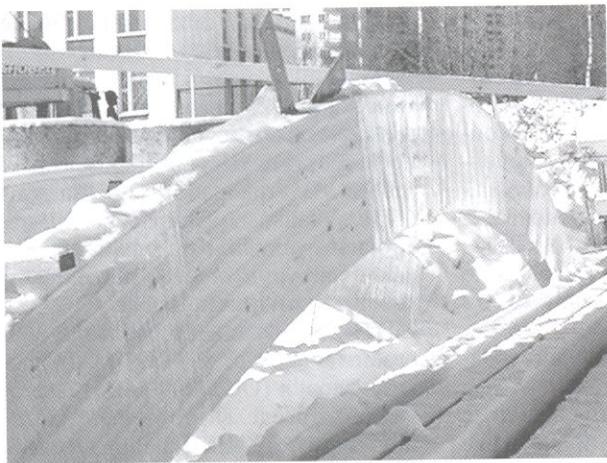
Неудовлетворительное хранение весьма ответственных КДК
